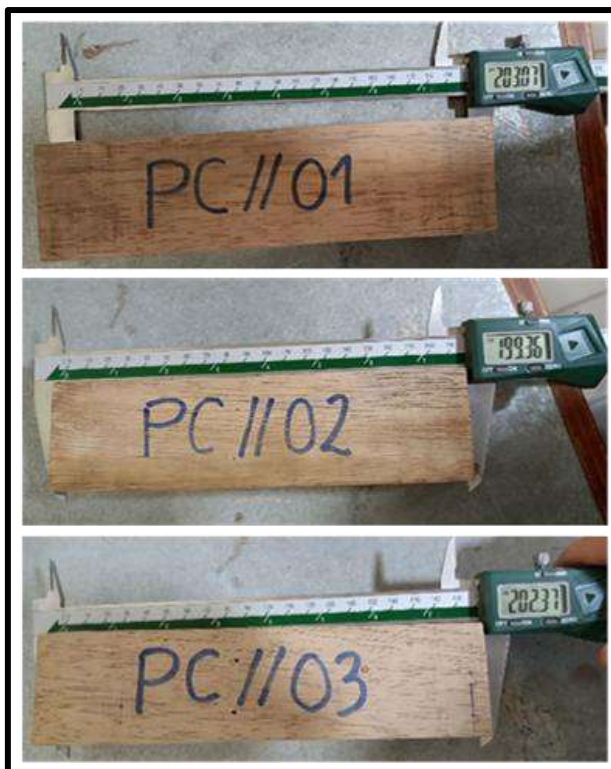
Dimensiones de probetas previas al ensayo de compresión perpendicular
